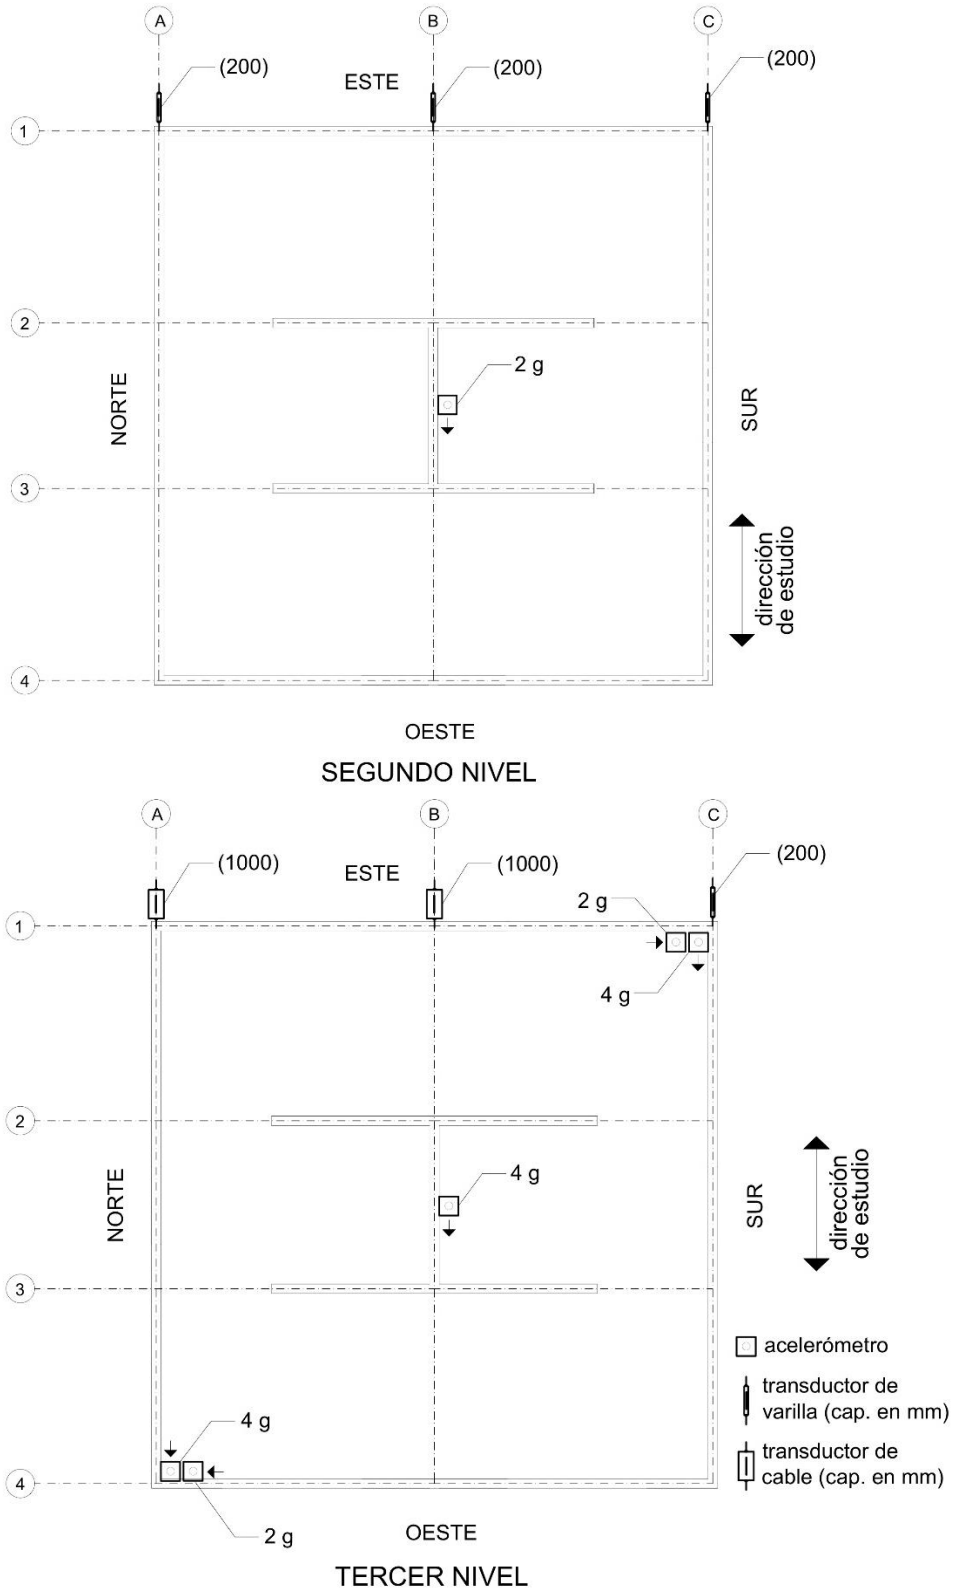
b. Distribución de acelerómetros y transductores de desplazamiento externos en planta
